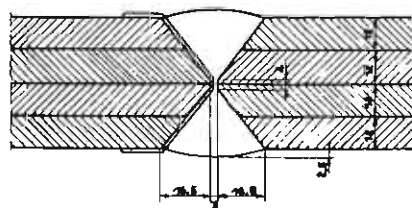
Coupe des cordons de soudure pour les semelles, dans la partie courante.
